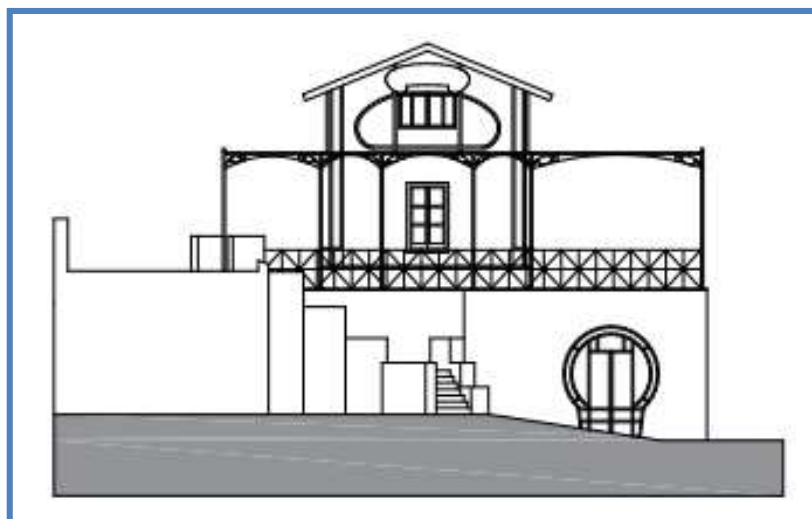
fabbricato ex inalazioni - PROSPETTO NORD-OVEST
